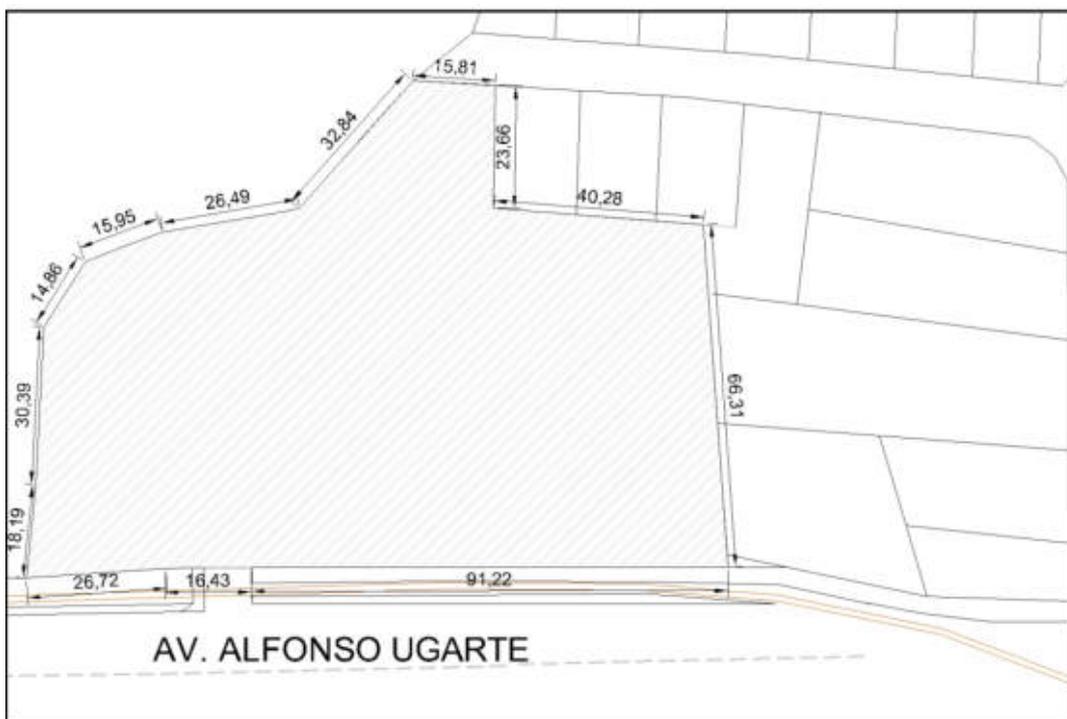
, Perímetro y linderos del terreno, Fuente: Elaboración propia.
